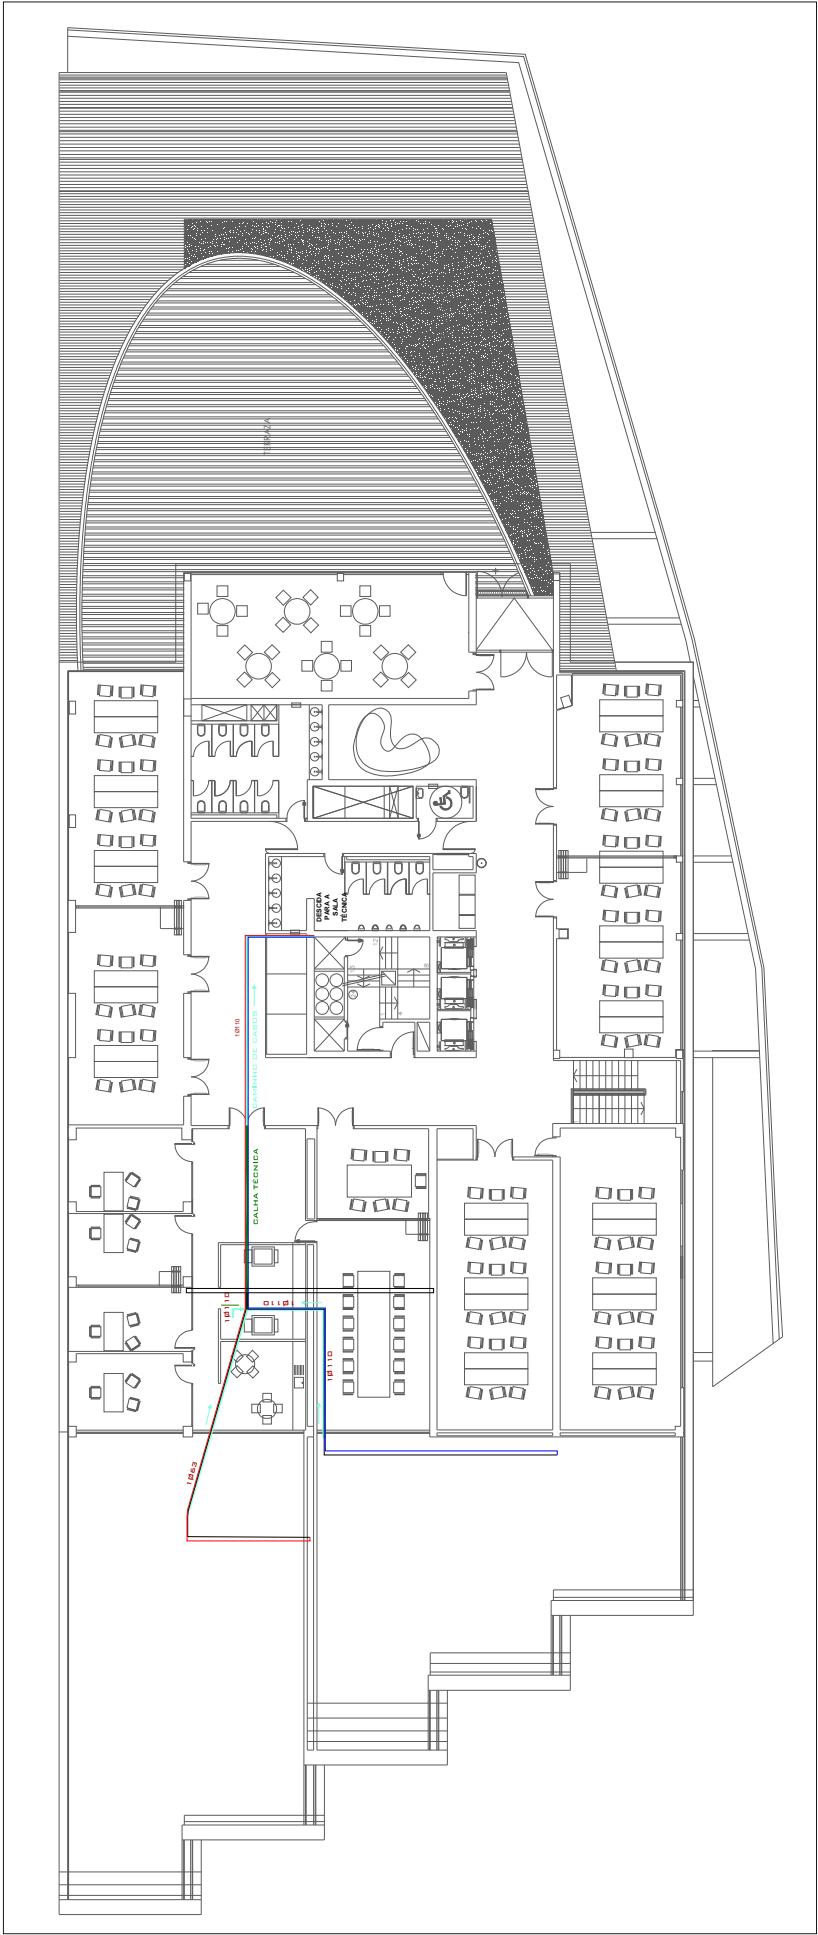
Planta da descida de cabos da cobertura para a sala técnica.
